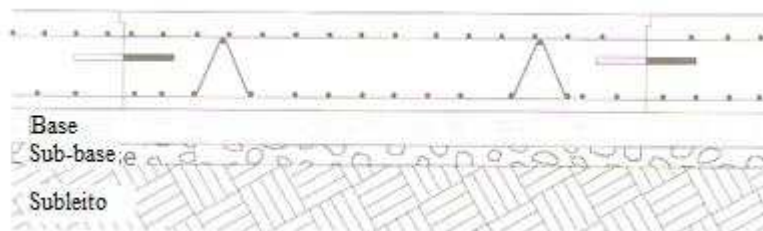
Seção transversal representativa de uma placa do pavimento de concreto armado (BALBO, 2009).
